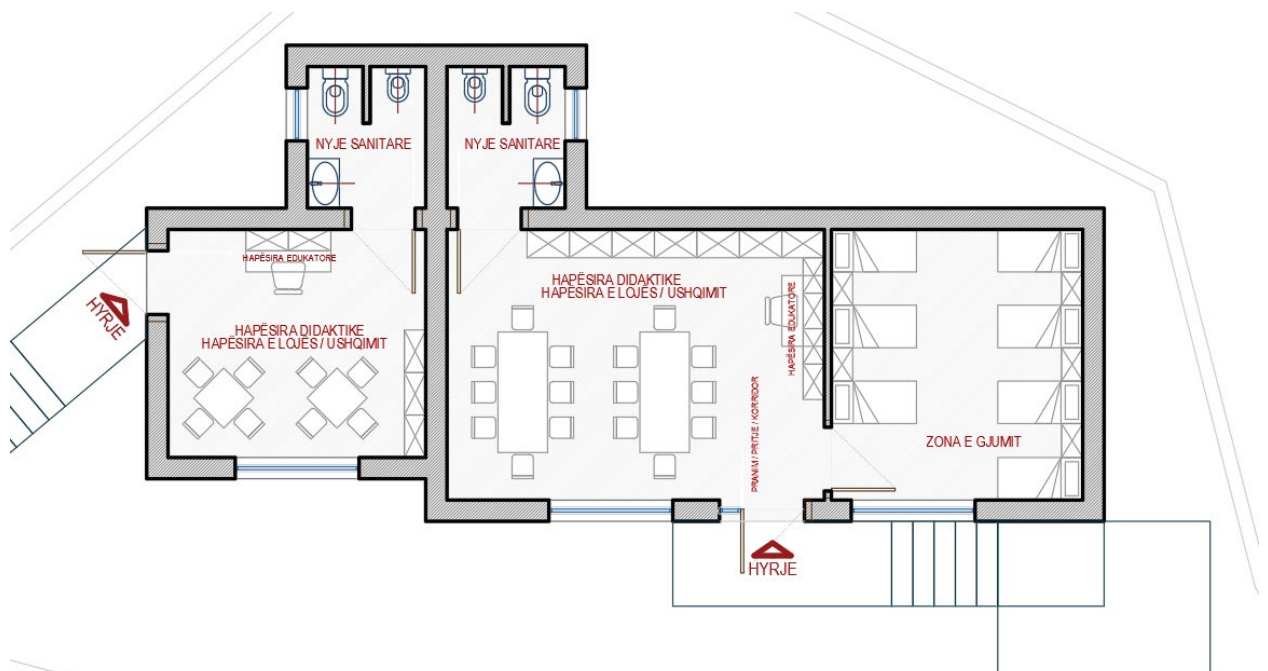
Planimetri kati 0, propozime _ Kopshti publik Shelegar, Sarandë
